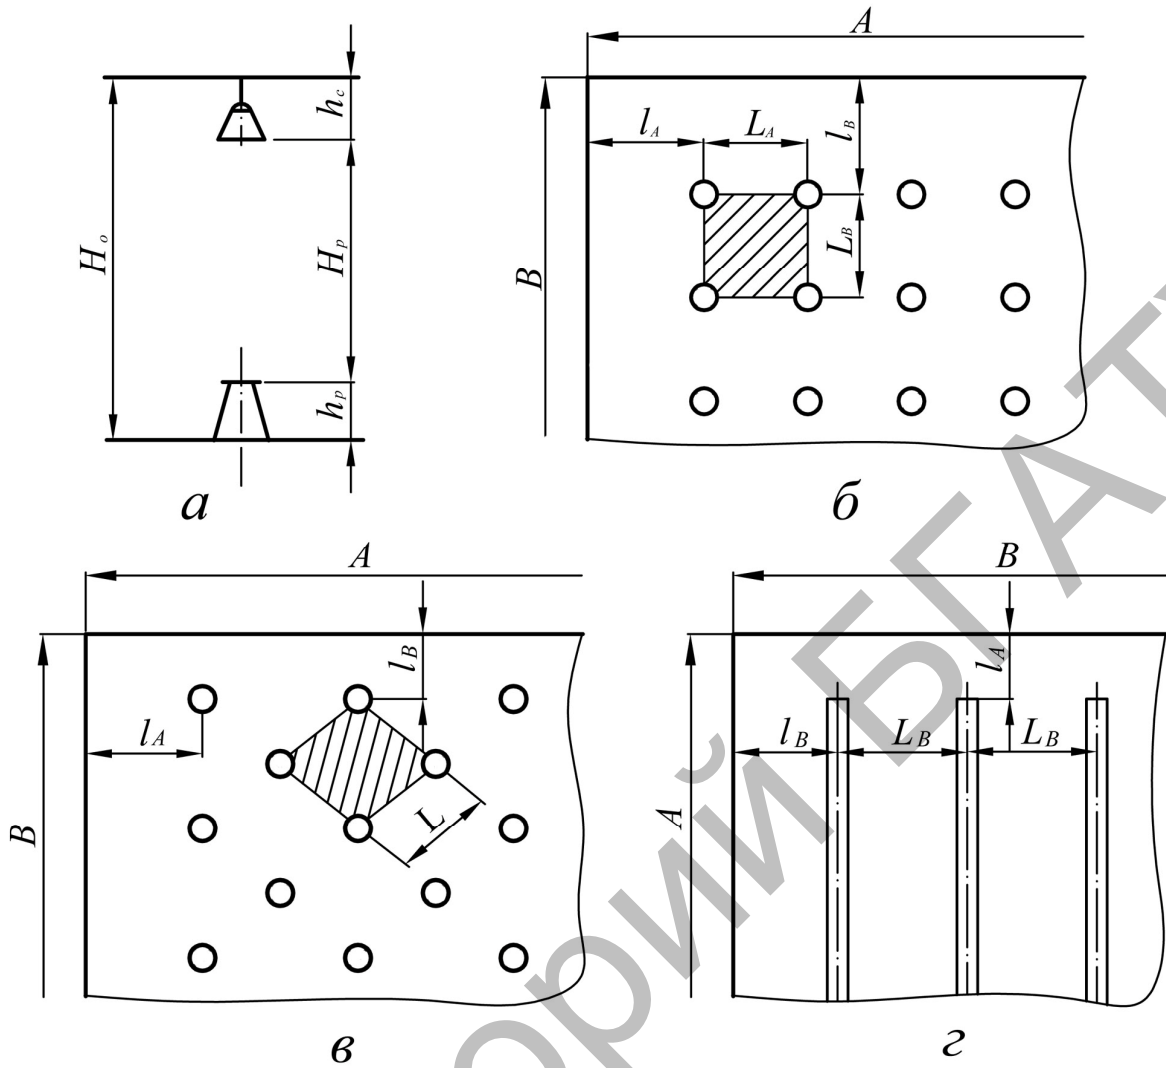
Варианты размещения светильников: а – в разрезе; б, в, г – в плане помещения: б – по углам прямоугольников; в – по вершинам ромба; г – в линию (для светильников с люминесцентными лампами)
